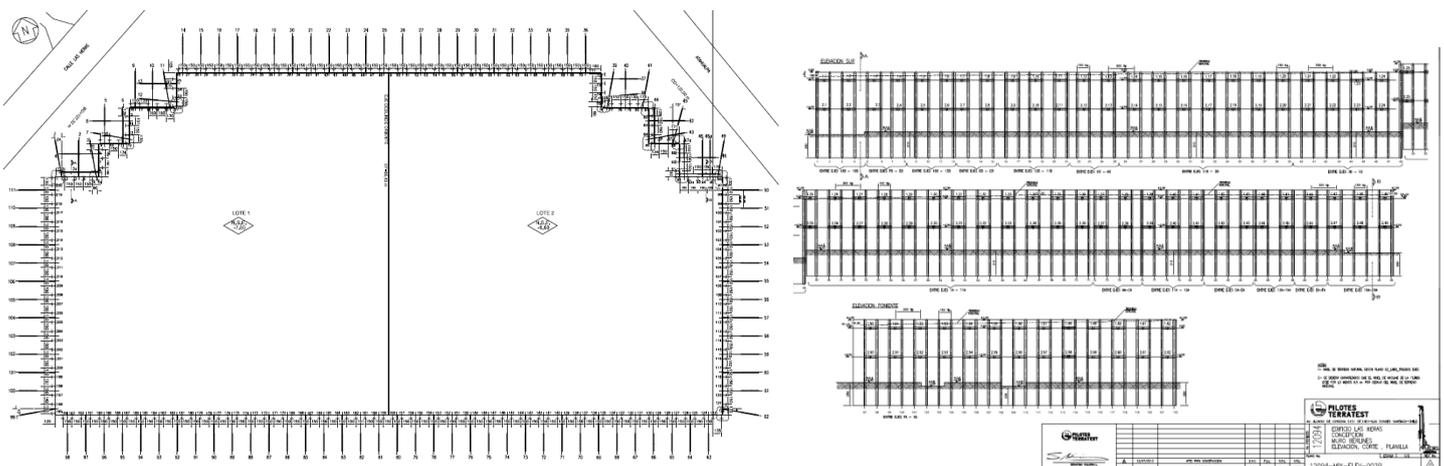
Vista en Planta y Cortes Típicos del Muro Berlínés
